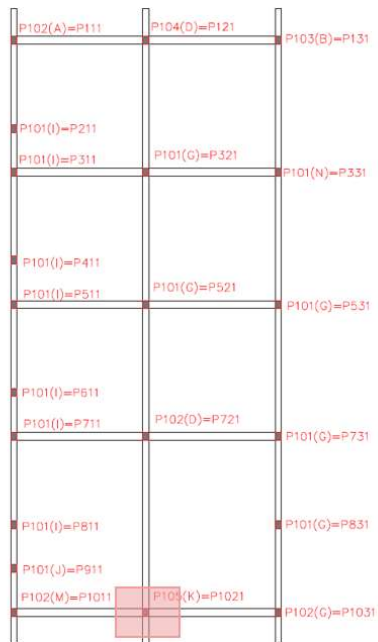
Planta estrutural com identificação do pilar a necessitar de reforço
